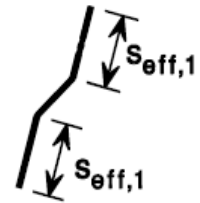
Sezione trasversale per la determinazione di I_s
